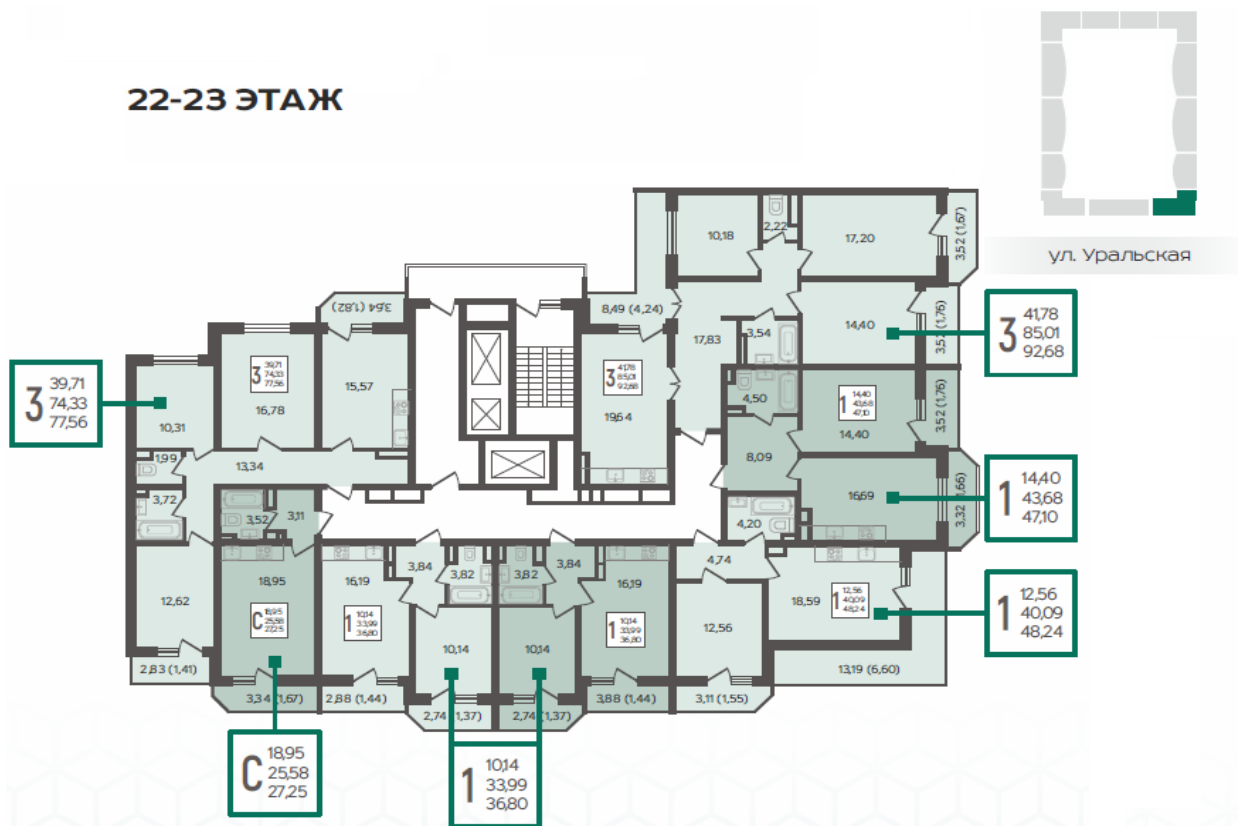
Типовой план 22-23 этажа БС-12 ЖК URAL
